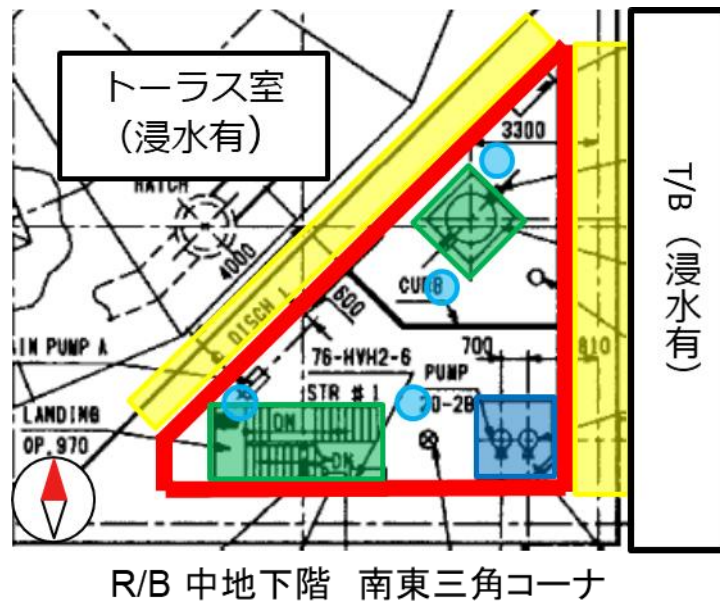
南東三角コーナへの津波の浸入経路（図中の色は表 4.1.3 と対応）
